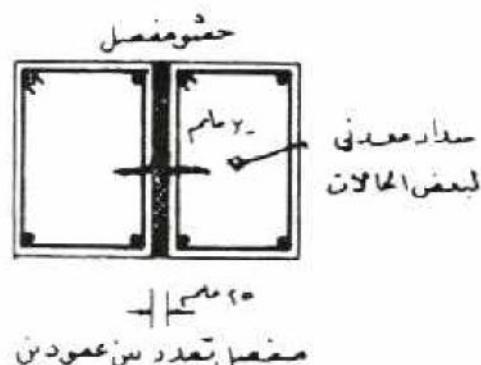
٤ ) مفاصل تمدد مع وسادة
